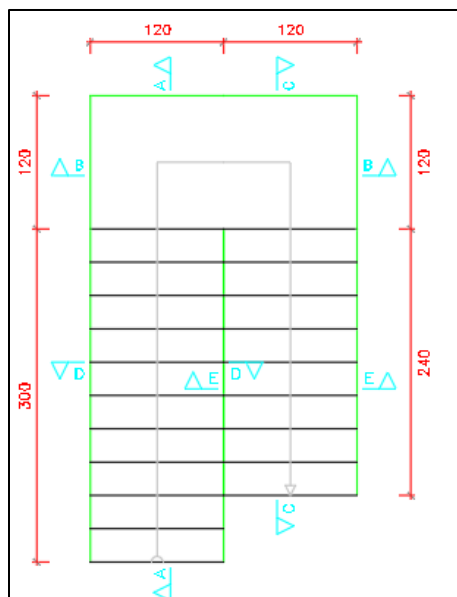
Planos estructurales de escalera corregida en escuela de enfermería.
